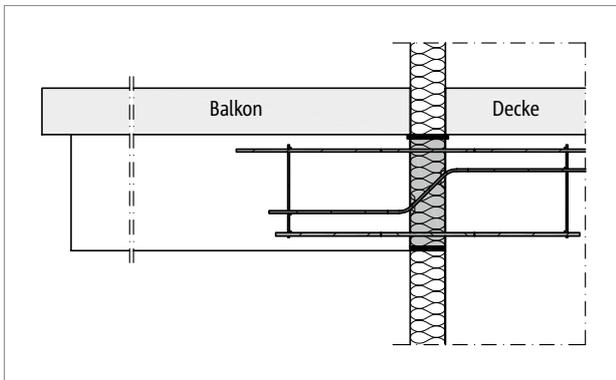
Schöck Isokorb® XT Typ B: Balkonkonstruktion mit frei auskragenden Unterzügen (Fertigteilbalkon)
